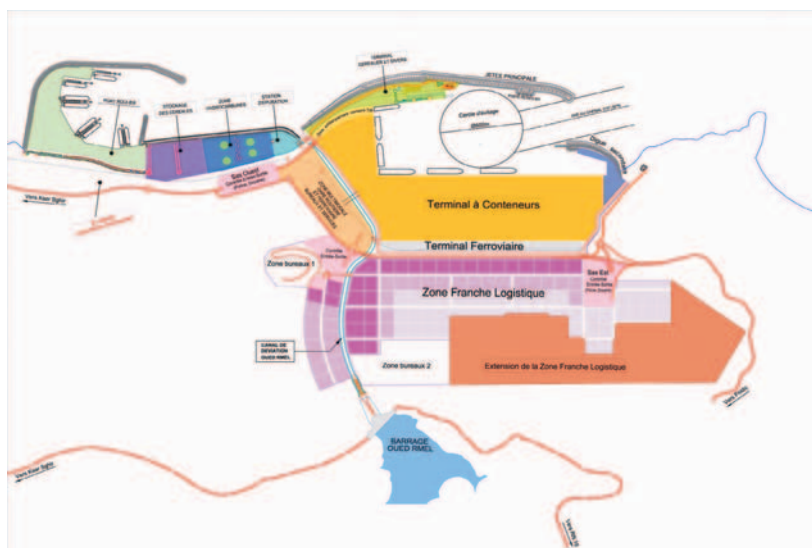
Plan masse provisoire du Complexe Portuaire
